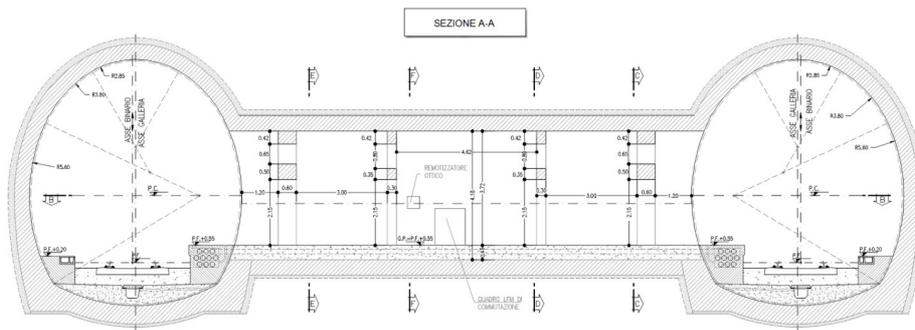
Collegamento trasversale di esodo (Scavo in tradizionale)
